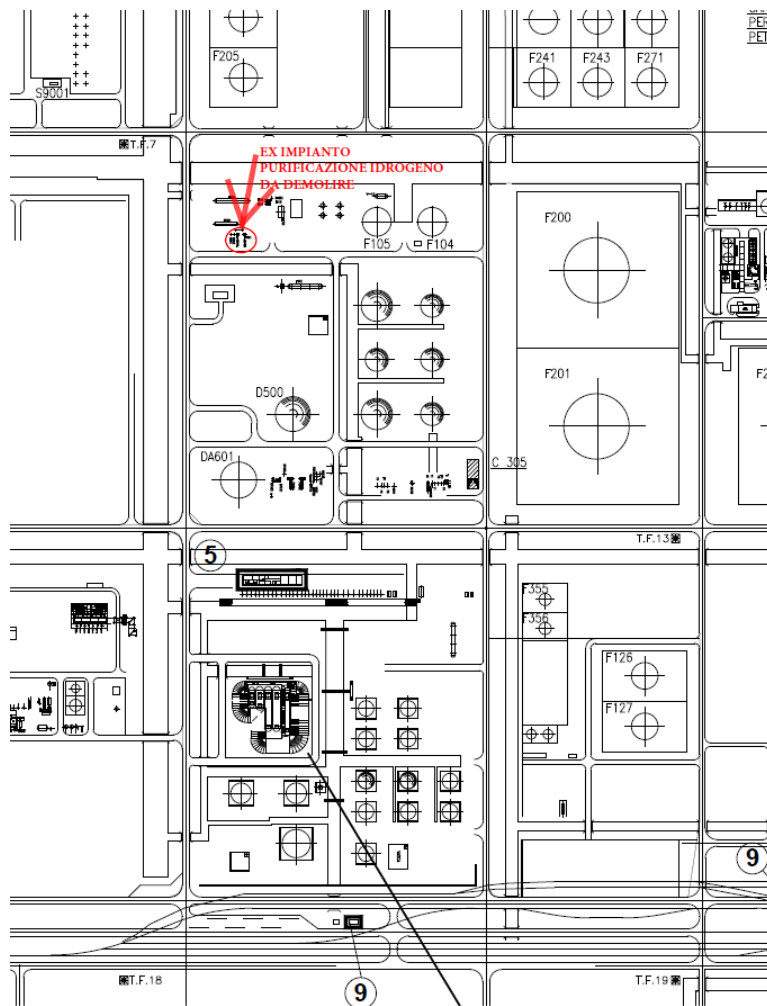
Stralcio planimetria stabilimento con individuazione dell'ex impianto di purificazione idrogeno.
